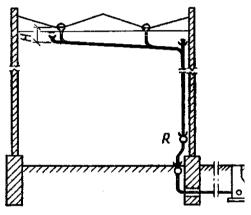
Схема внутреннего водостока с двумя воронками, объединенными подвесным трубопроводом с закрытым выпуском
